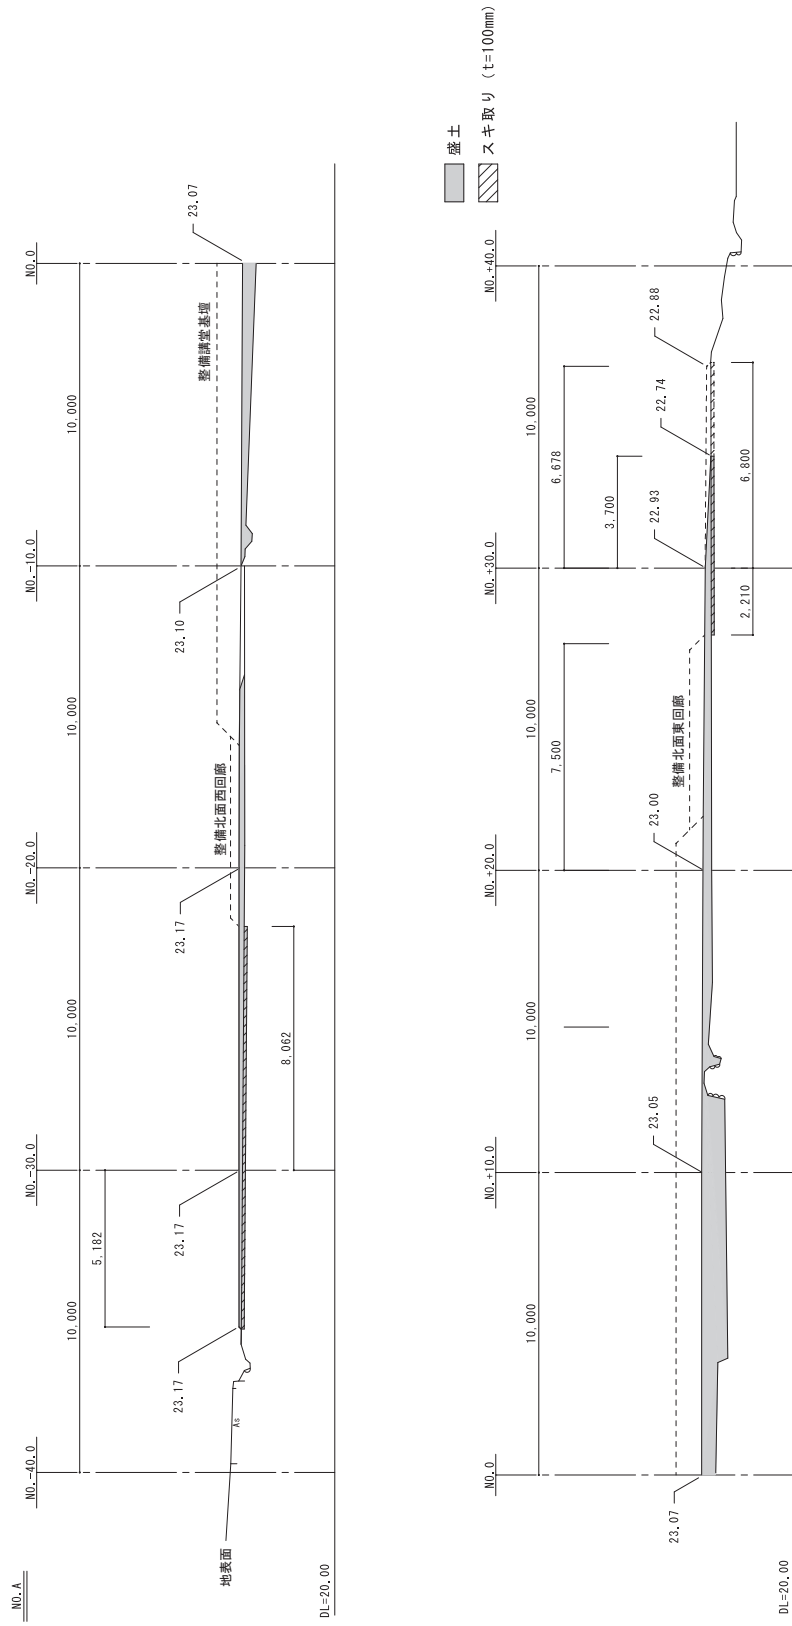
講堂地区 基礎造成断面図 (No.A) (1/250)
